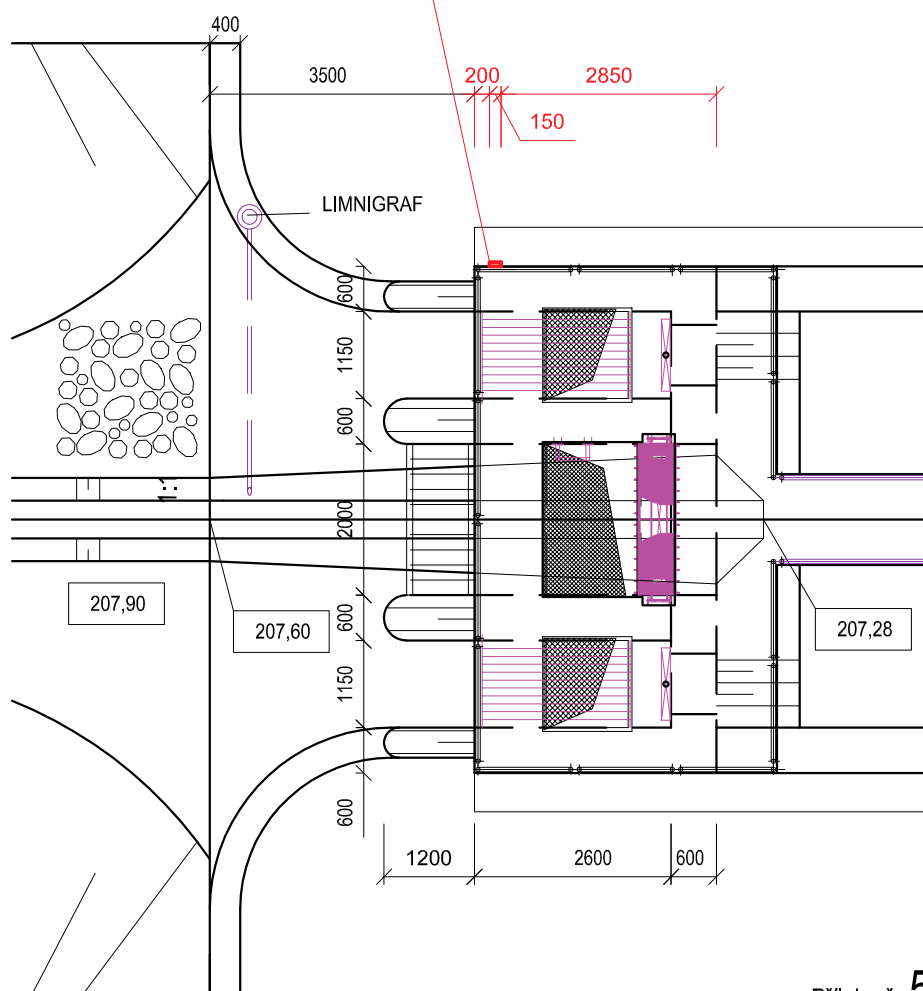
DETAIL UMÍSTĚNÍ VODOČETNÉ LATĚ - PŮDORYS
